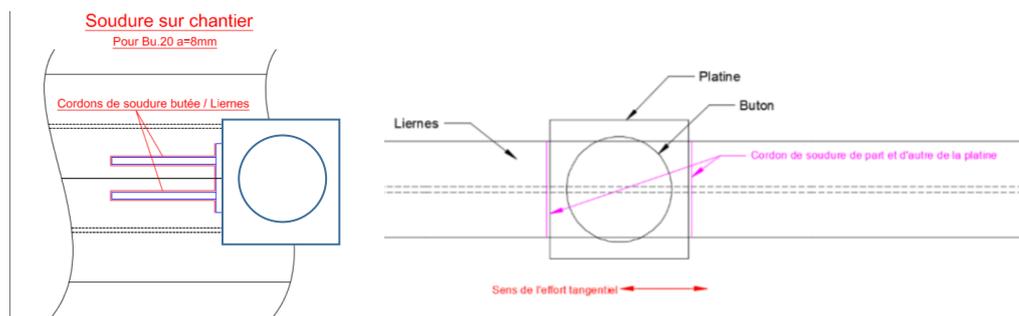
Optimisation des soudures pour la pose des butons
